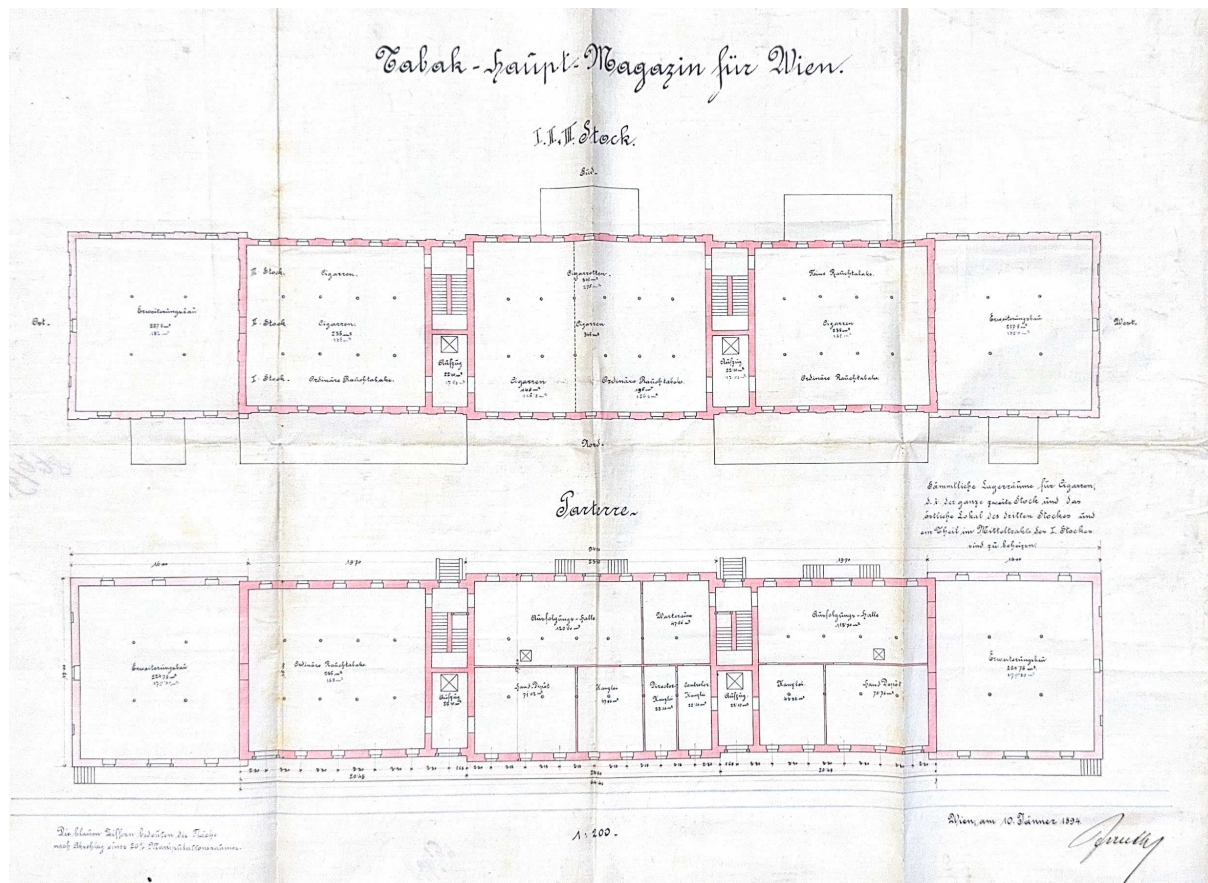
Tabakhauptmagazin in Wien, Grundrisse, 1894.
